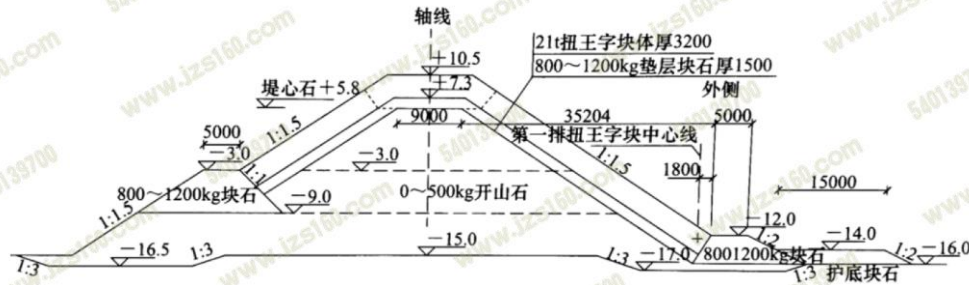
防波堤典型断面图 (图中单位: 尺寸为 mm、标高为 m)
